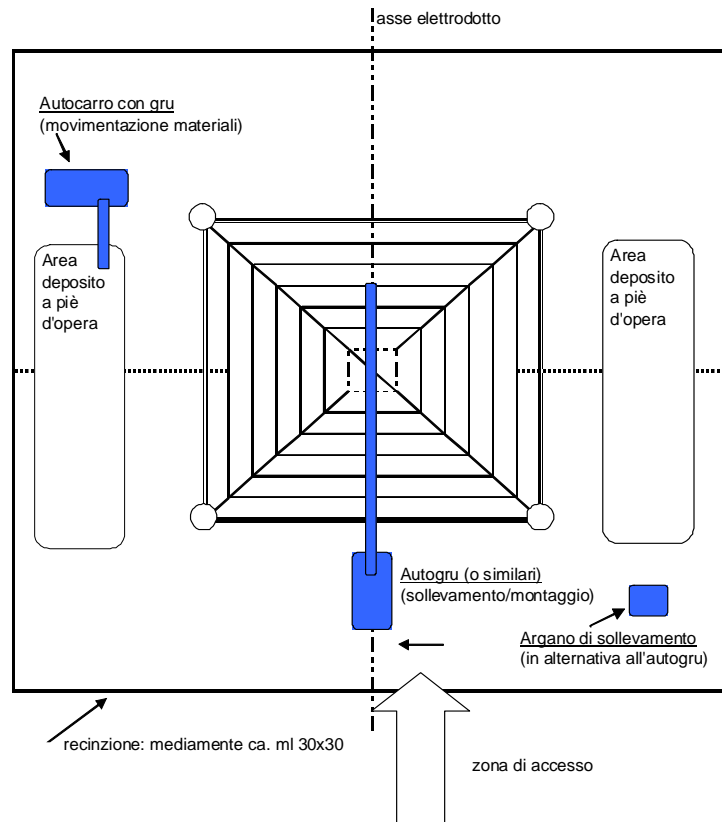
Planimetria dell'Area Sostegno (montaggio sostegno)
